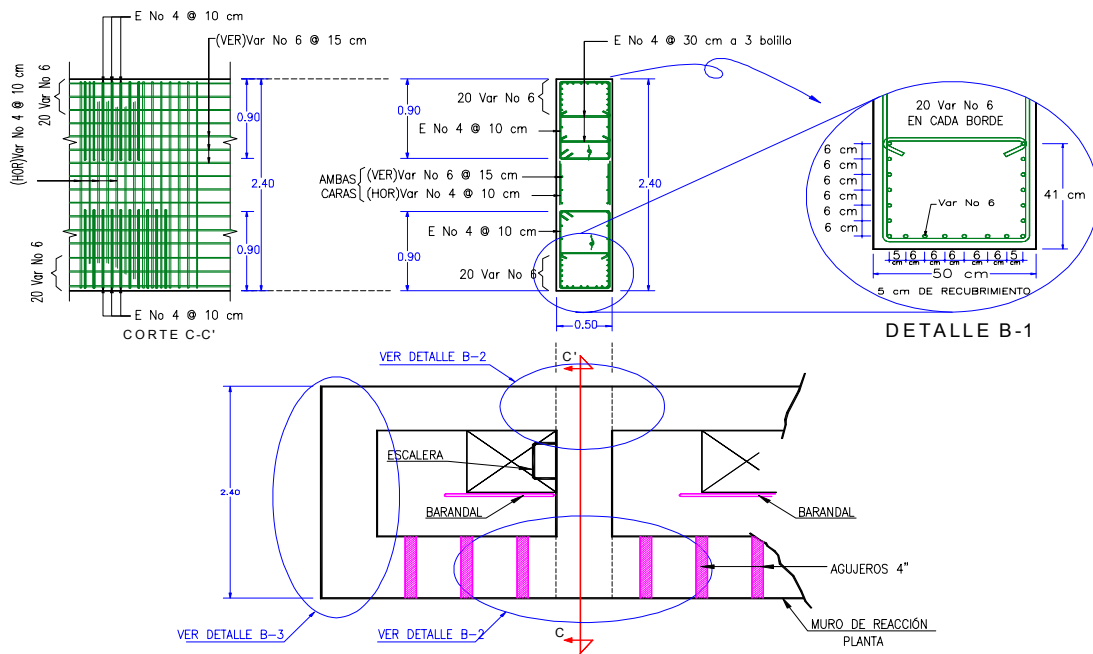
Armado de refuerzo para los muros de cortante del Muro de Reacción.
